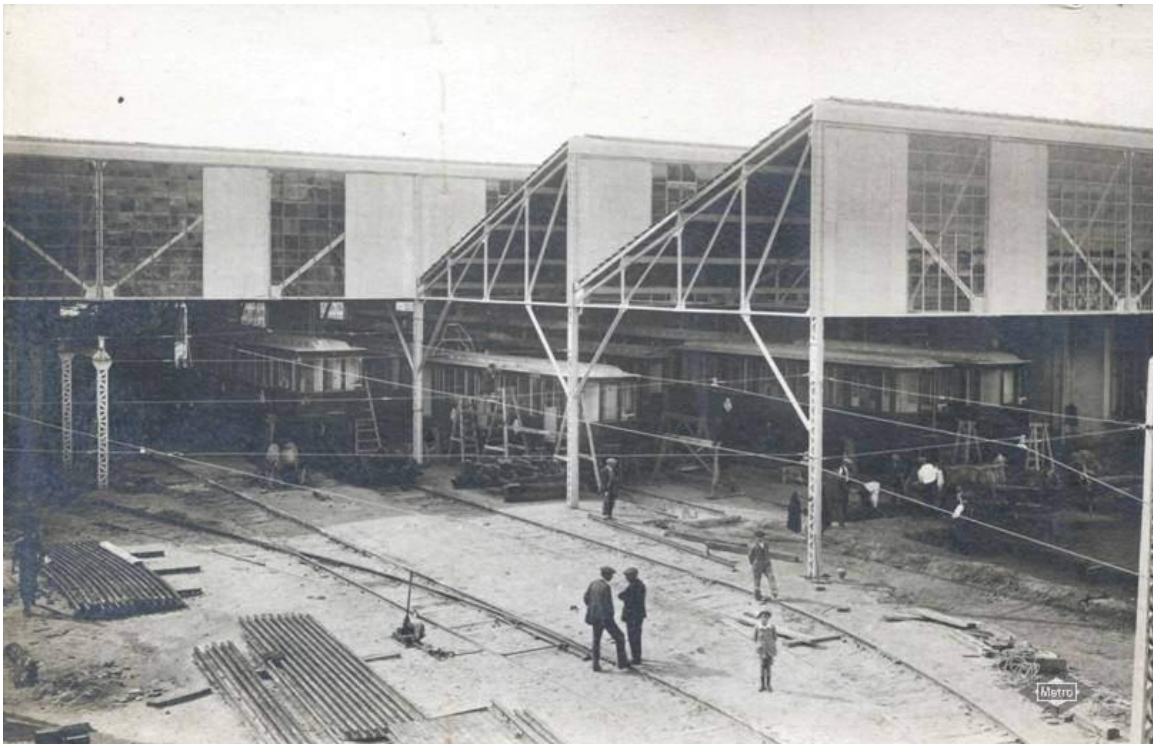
y 21.-Construcción de las naves A y B, 1919. Montaje de la estructura metálica de las cocheras. La más moderna tecnología convive con los tiros de bueyes. Los acopios de ladrillos y traviesas nos indican el papel de Cuatro Caminos como centro logístico de las obras. Nótese los viandantes asomados al pretil en la esquina izquierda de ambas foto, lo que indica la voluntad por parte del proyectista de incorporar el edificio a la escena urbana. Archivo Metro
